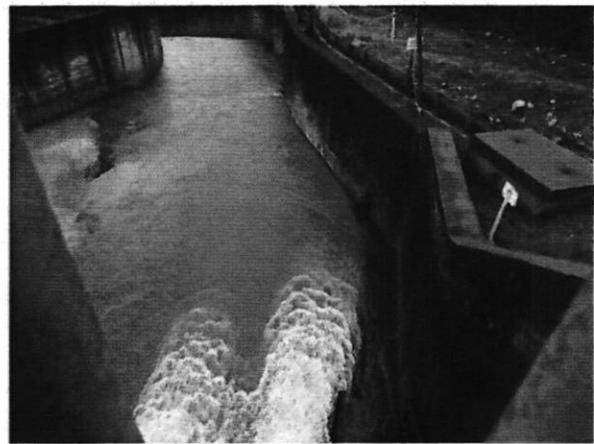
e 14 – Vista da Barragem Baixo João Pereira.
